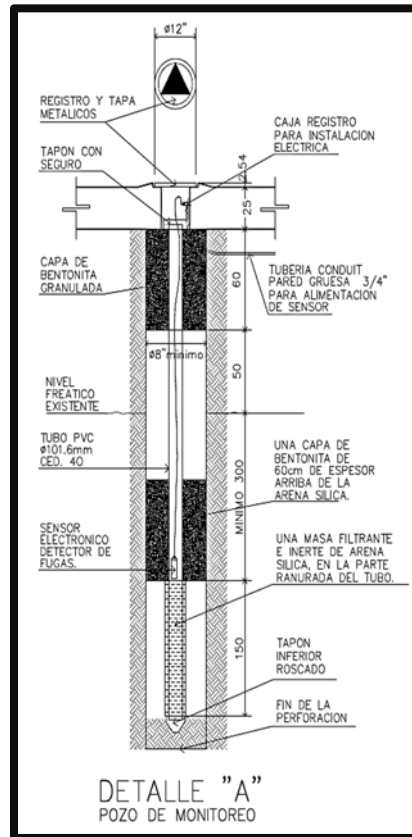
CORTE DETALLES DEL POZO DE OBSERVACIÓN
